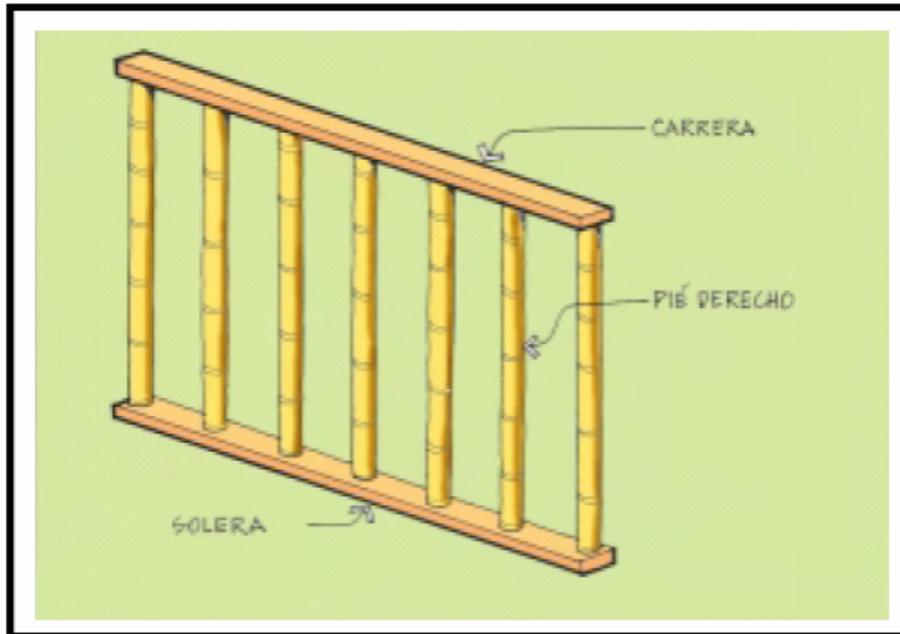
Panel estructural no arriostrado. Fuente AIS
